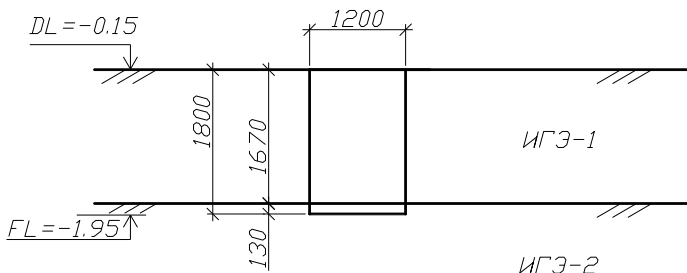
Схема к определению глубины заложения подошвы фундамента
